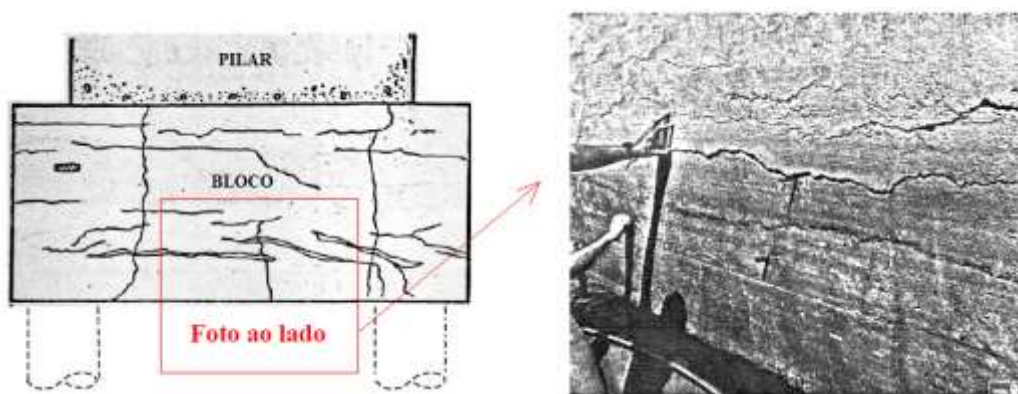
Bloco sobre estacas com fissuras devido a detalhamento da armadura de flexão deficiente
